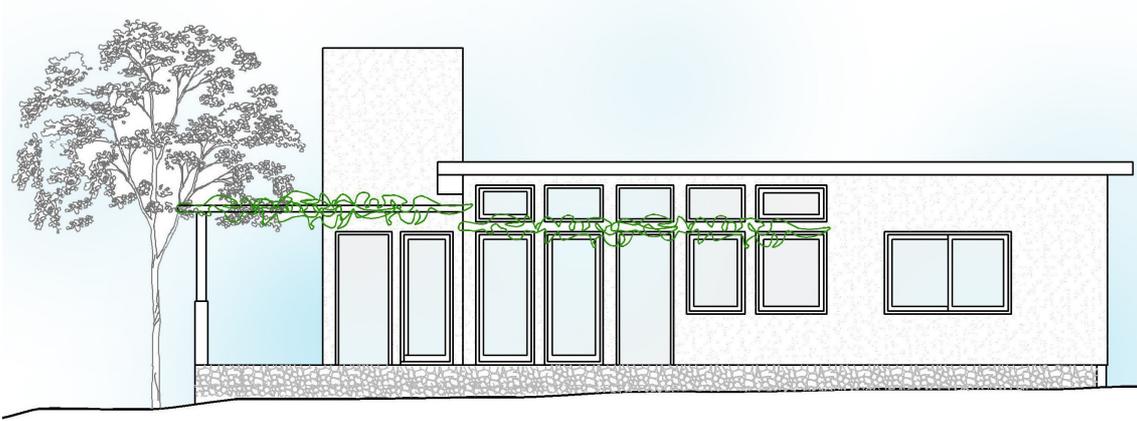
Fachada Norte, donde se observa la superficie acristalada (15.3m^2), respecto del total de la fachada Norte (30.3m^2)
